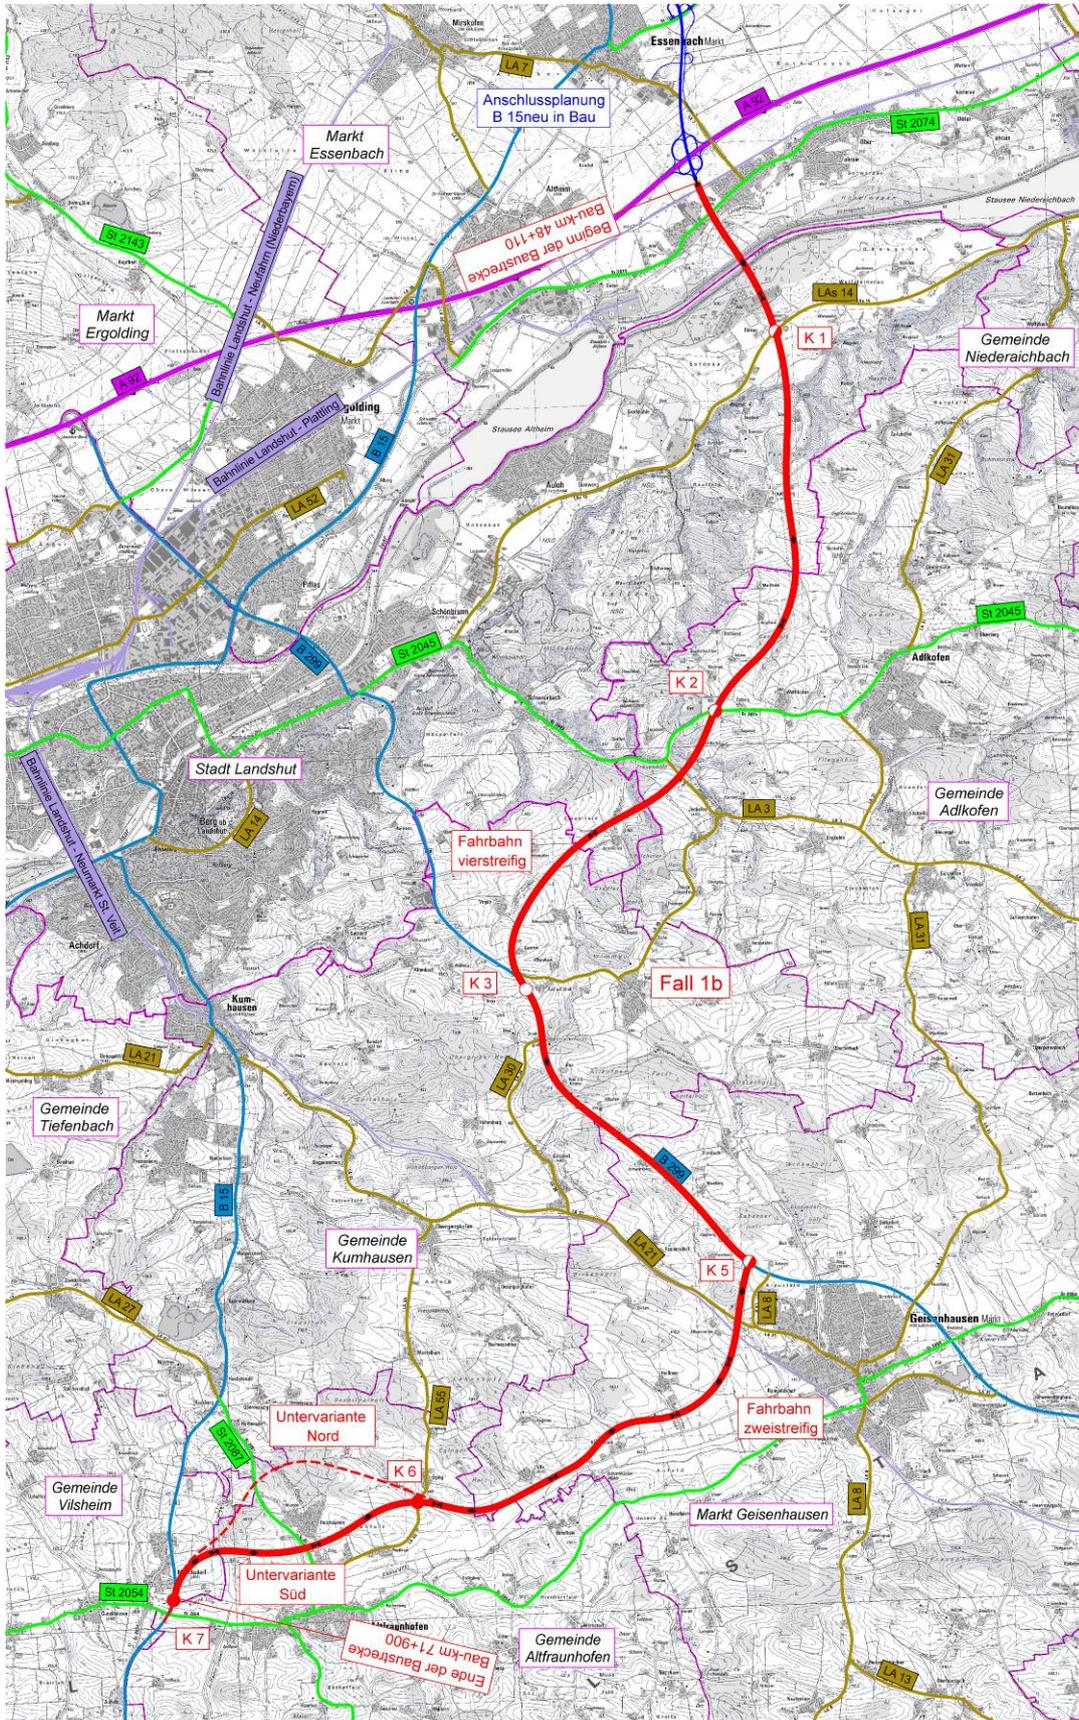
Lageplan Planfall 1b (Unterlage 3, Blatt 3)
